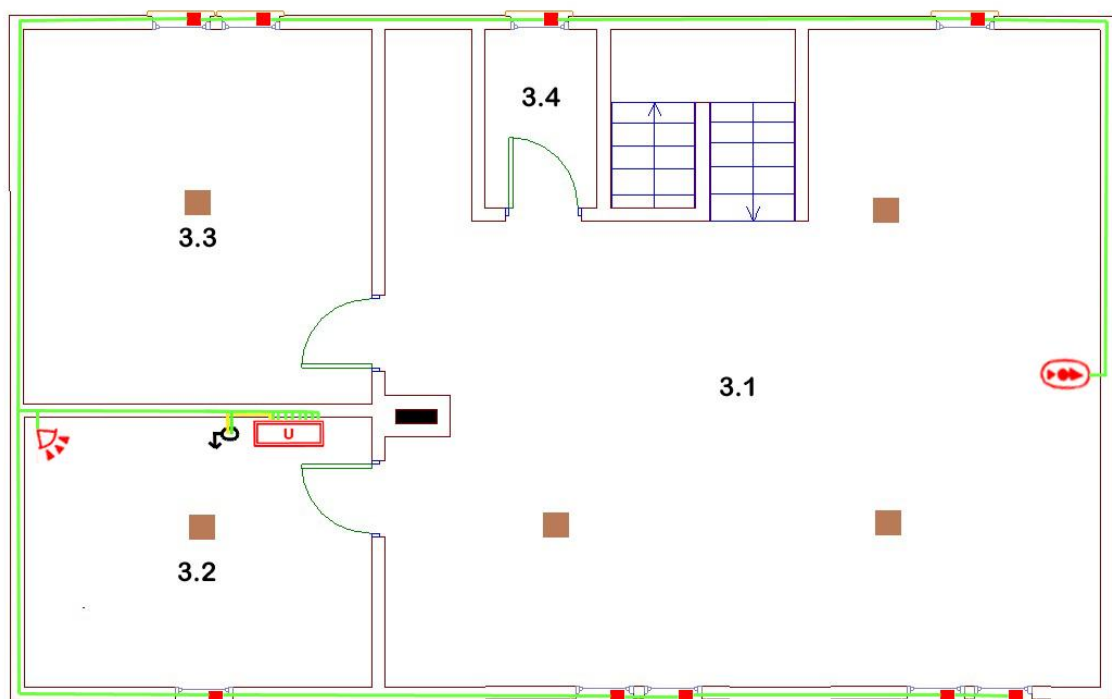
Rozmístění komponentů ve sklepním prostoru
